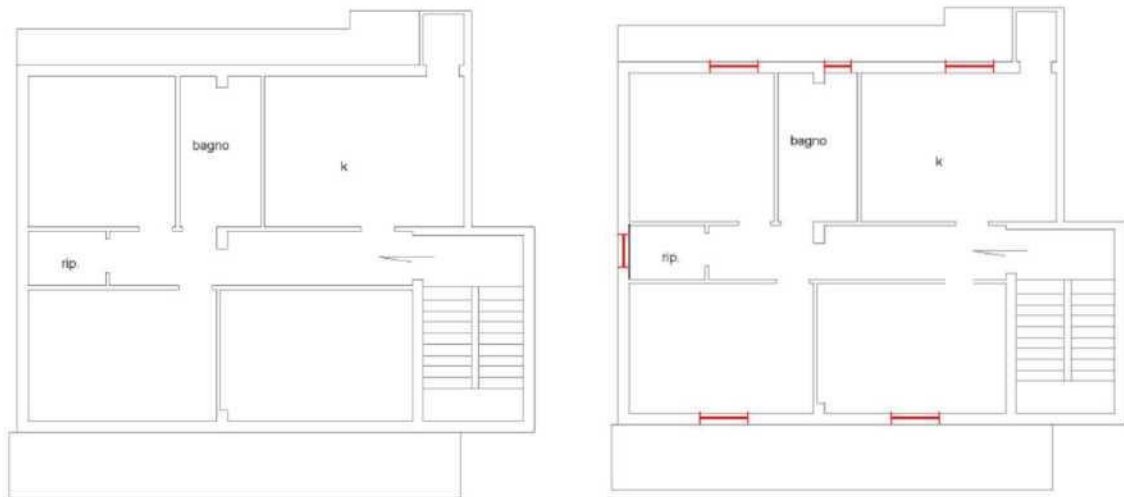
Planimetria catastale dell'appartamento posto al piano terzo sub 12 e rilievo stato di fatto
